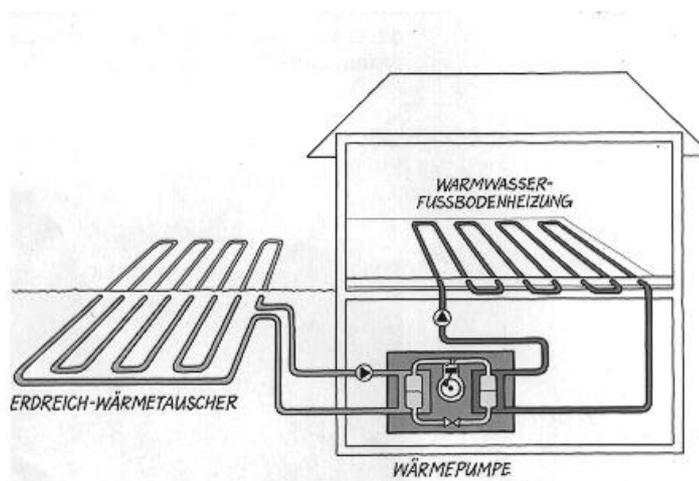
Schema einer Erdreich-Wärmepumpenanlage [TGA 1/97]
